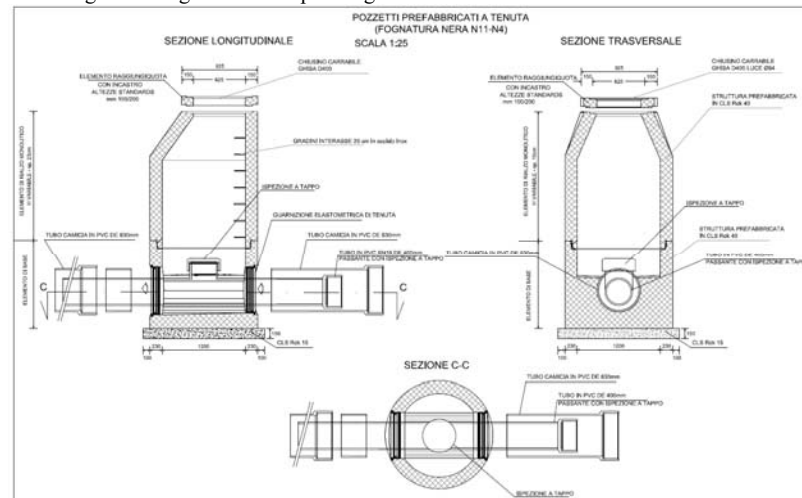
Pozzetti prefabbricati a tenuta nel tratto di interferenza con la zona di rispetto allargata
